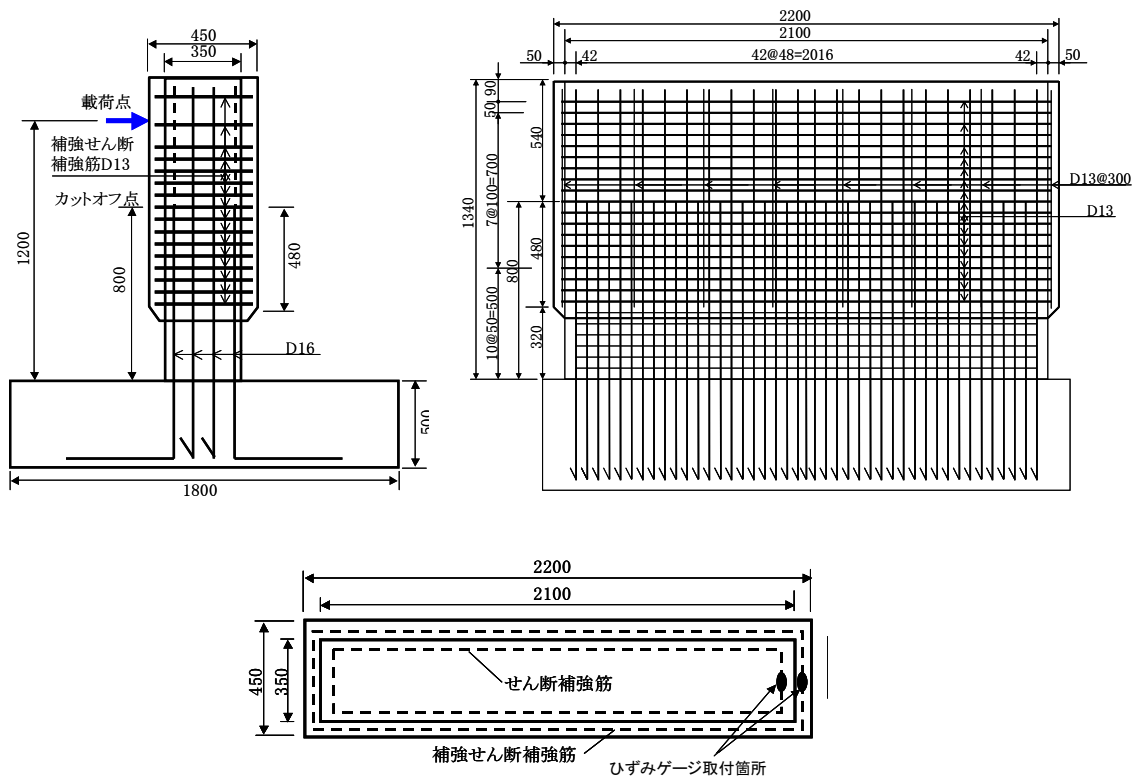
試験体の形状及び配筋図 (Type2-2の例)
